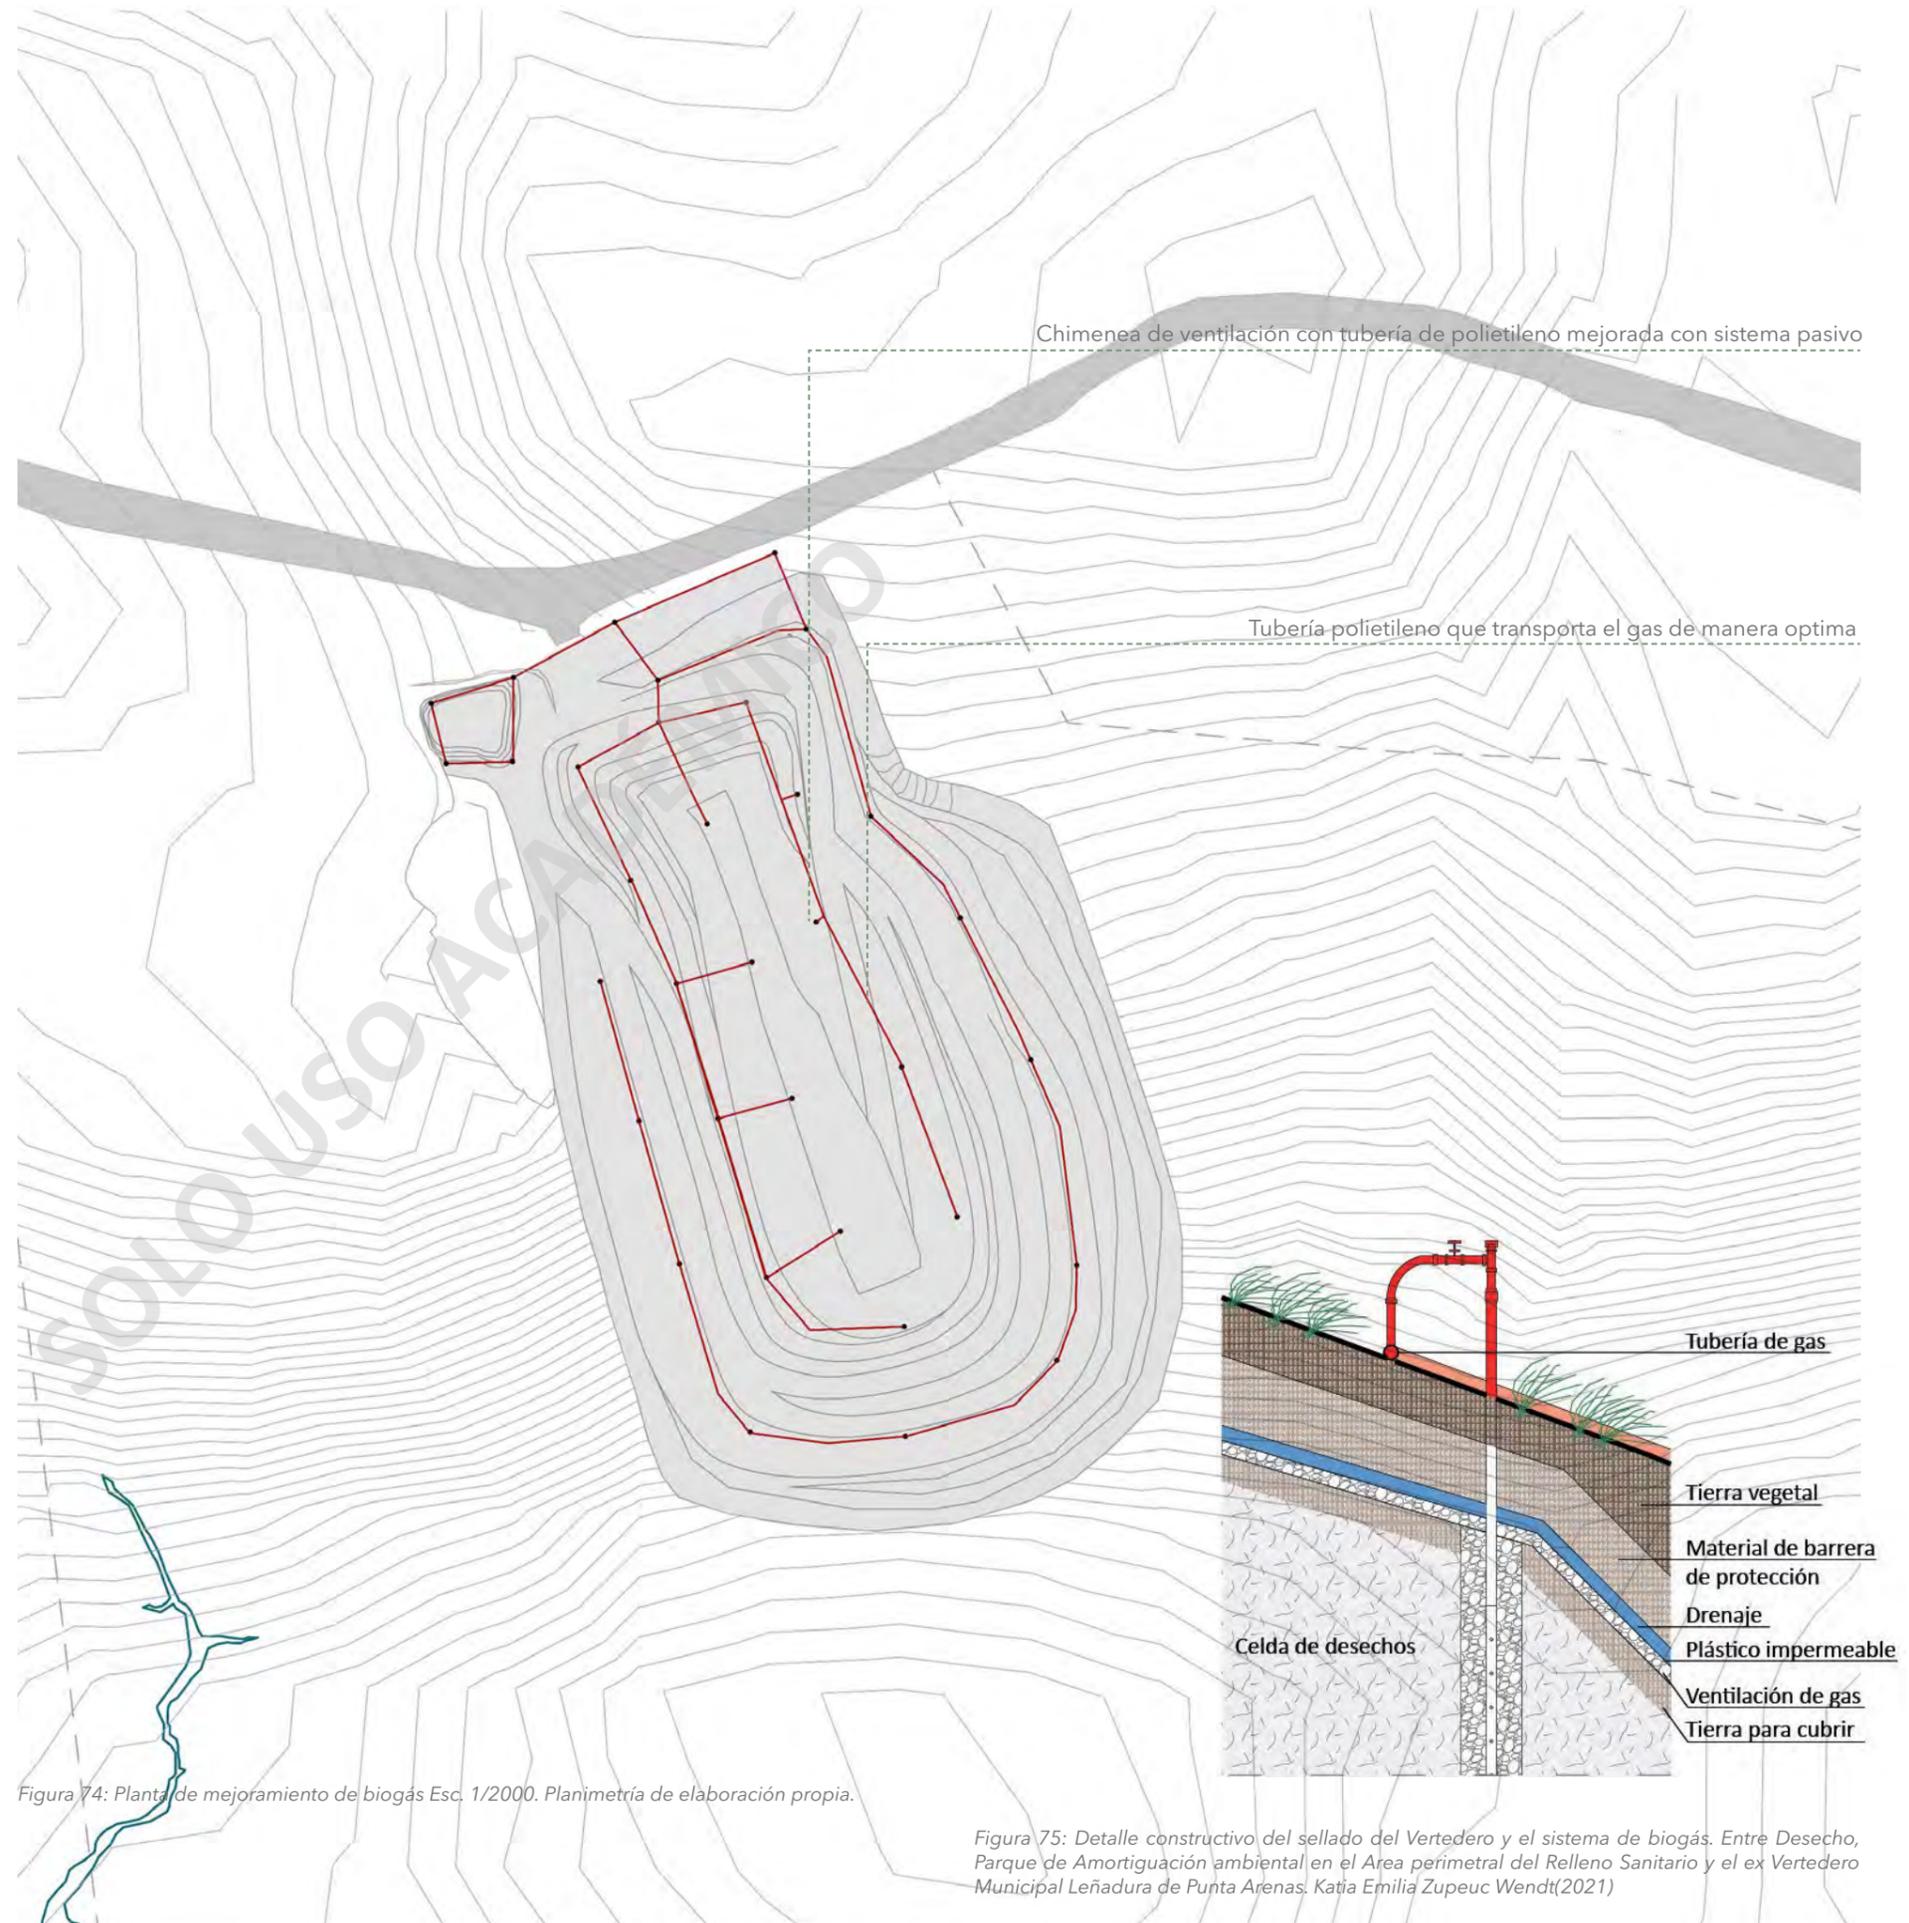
Planta de mejoramiento de biogás Esc. 1/2000. Planimetría de elaboración propia.
